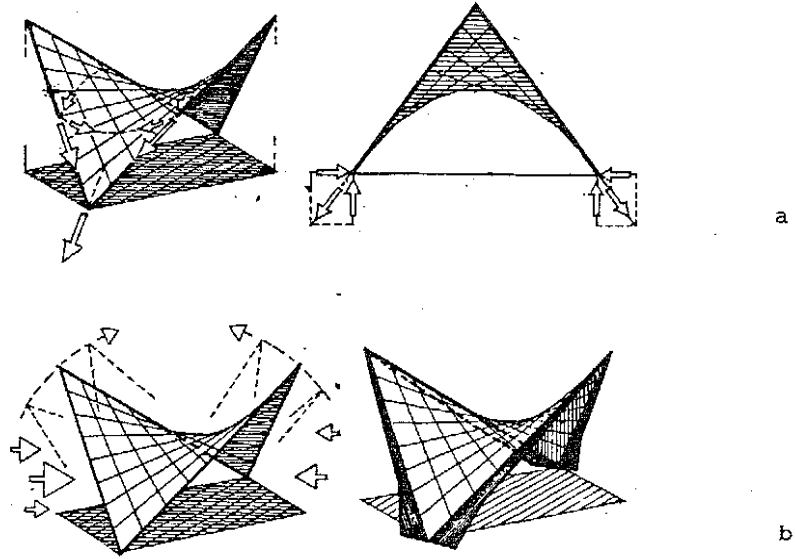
Düz Kenarlı H.P. Görünüş ve Planı
